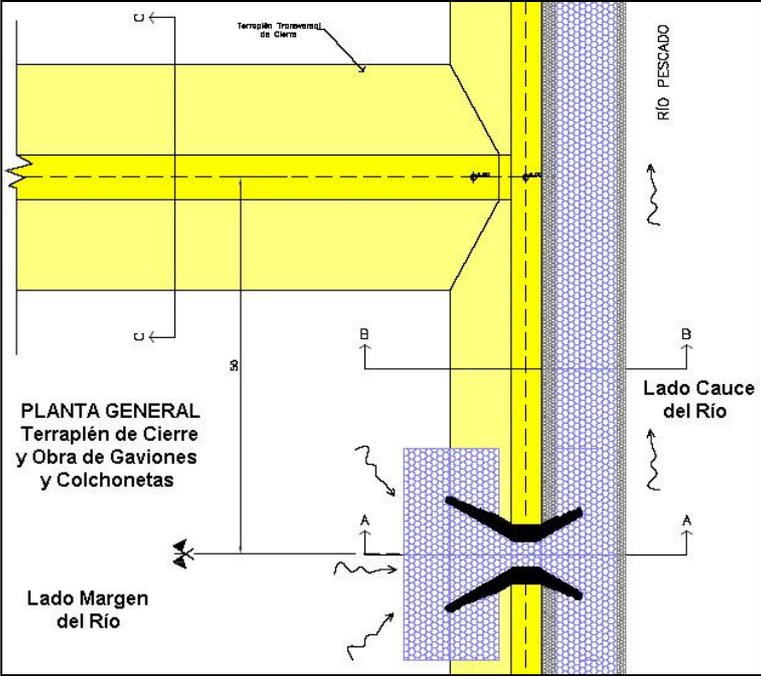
Vista en planta. Obra de Paso en concordancia con el Terraplén de cierre Transversal.
